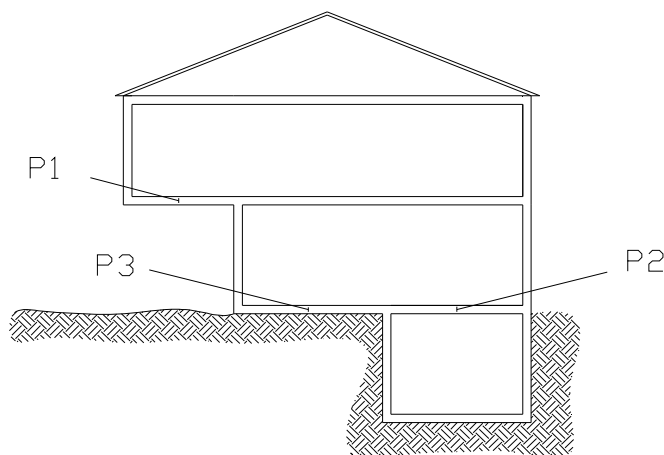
Localização dos pavimentos tipo em estudo
